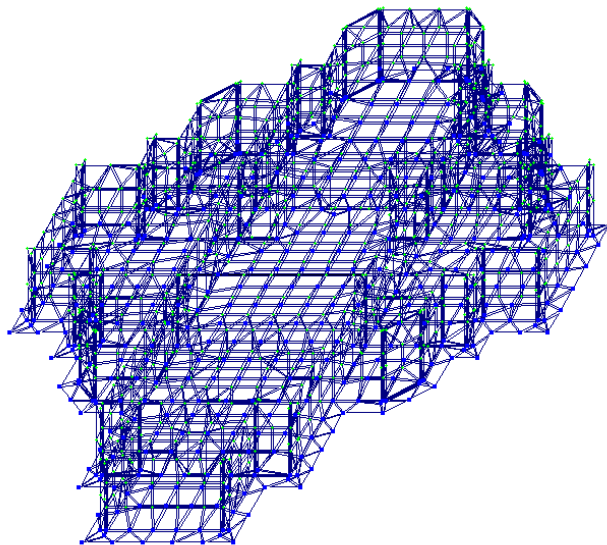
Расчетная схема цокольной части здания на плитном фундаменте
